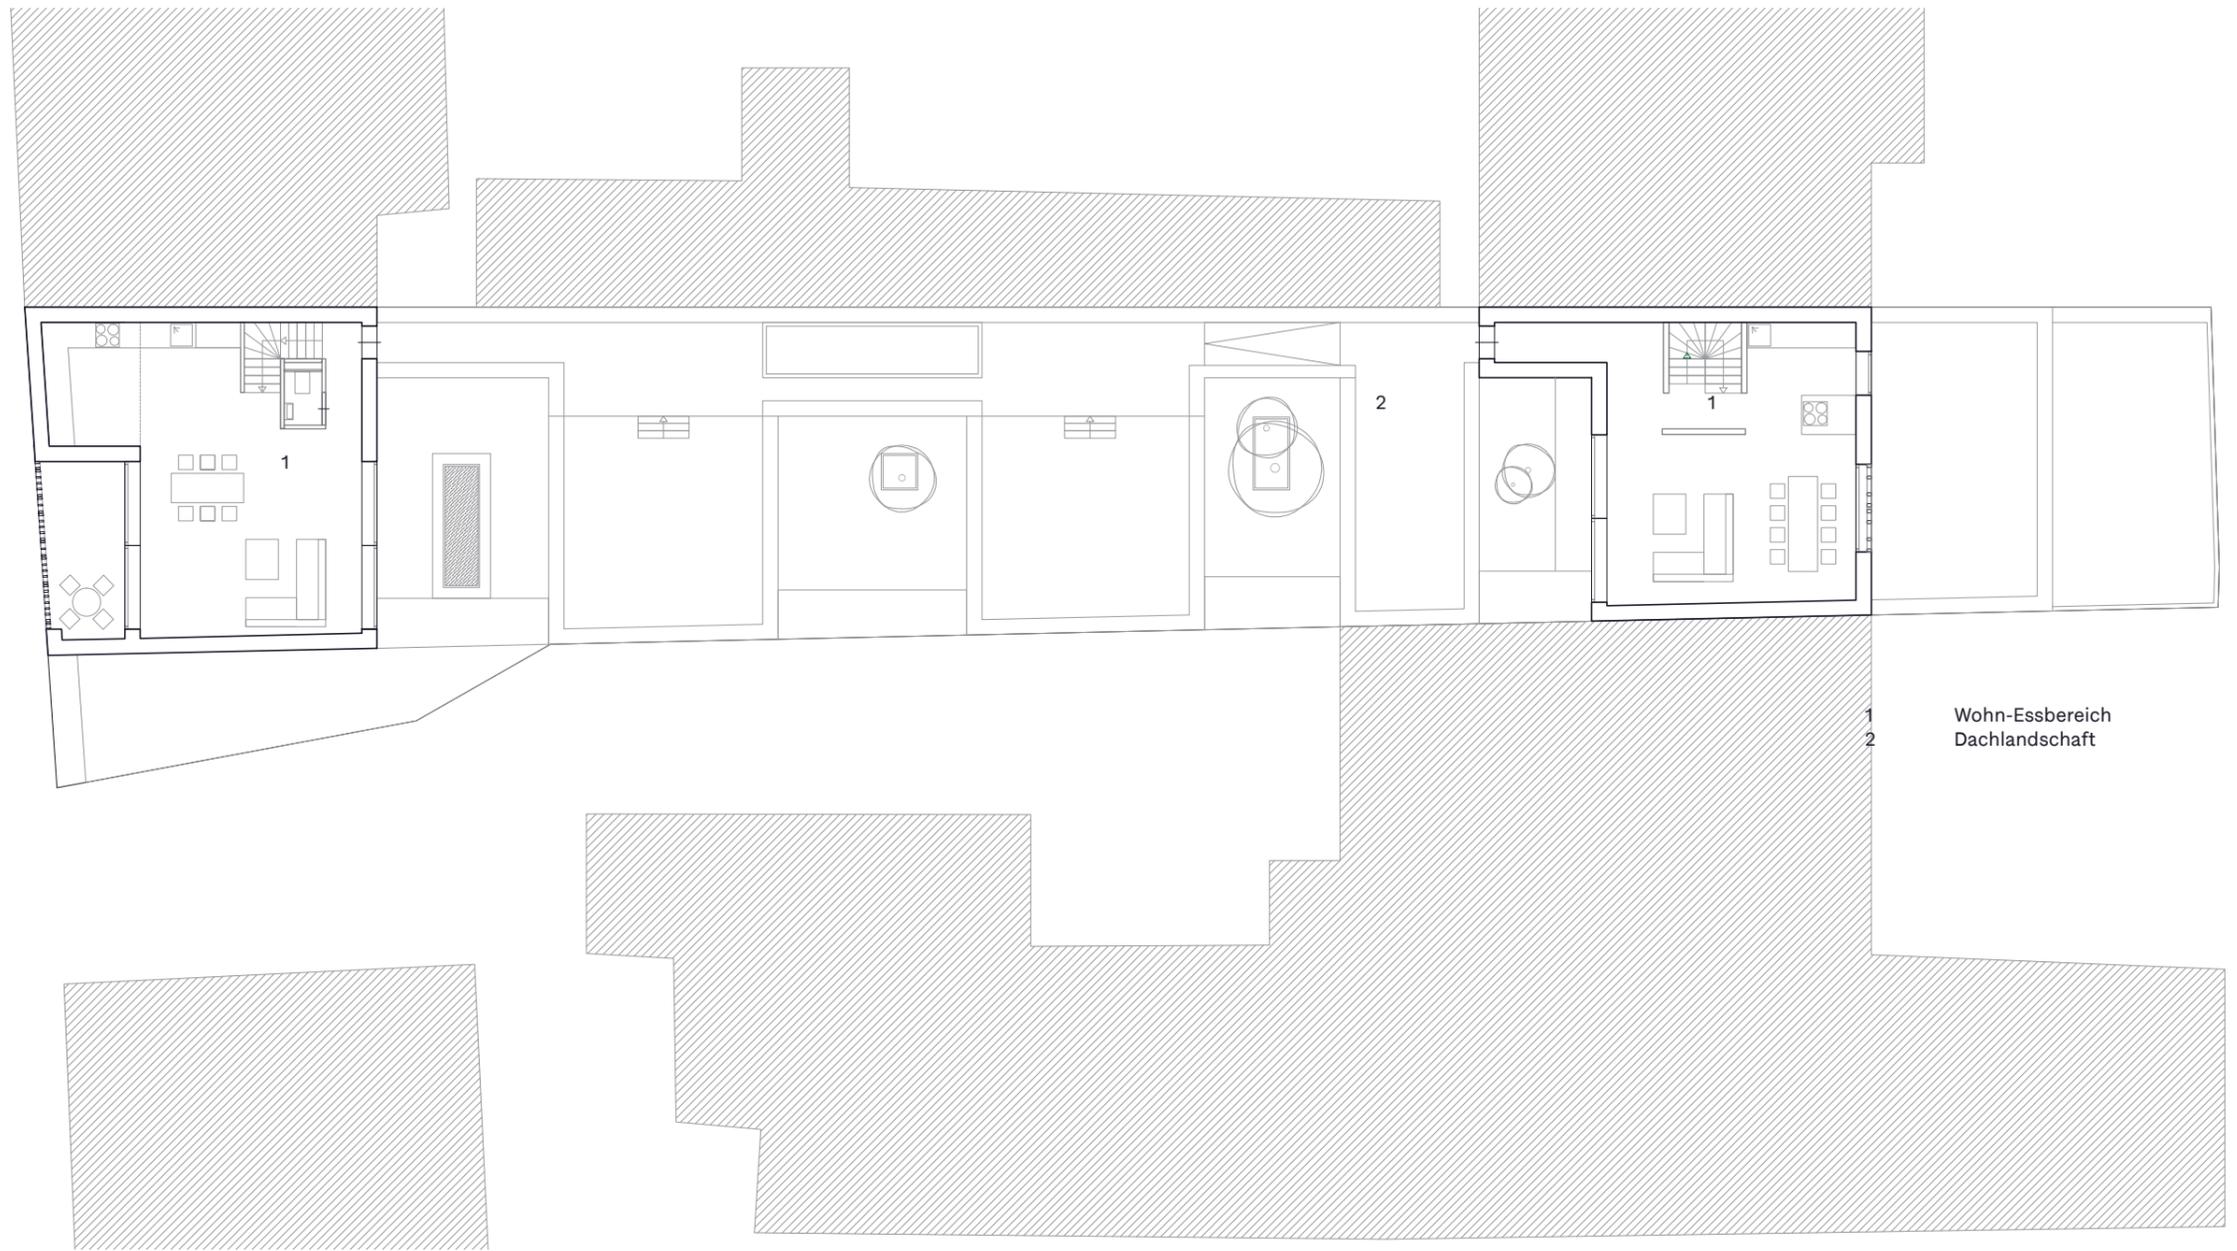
Grundriss Ebene 2 Idlhöfe101
